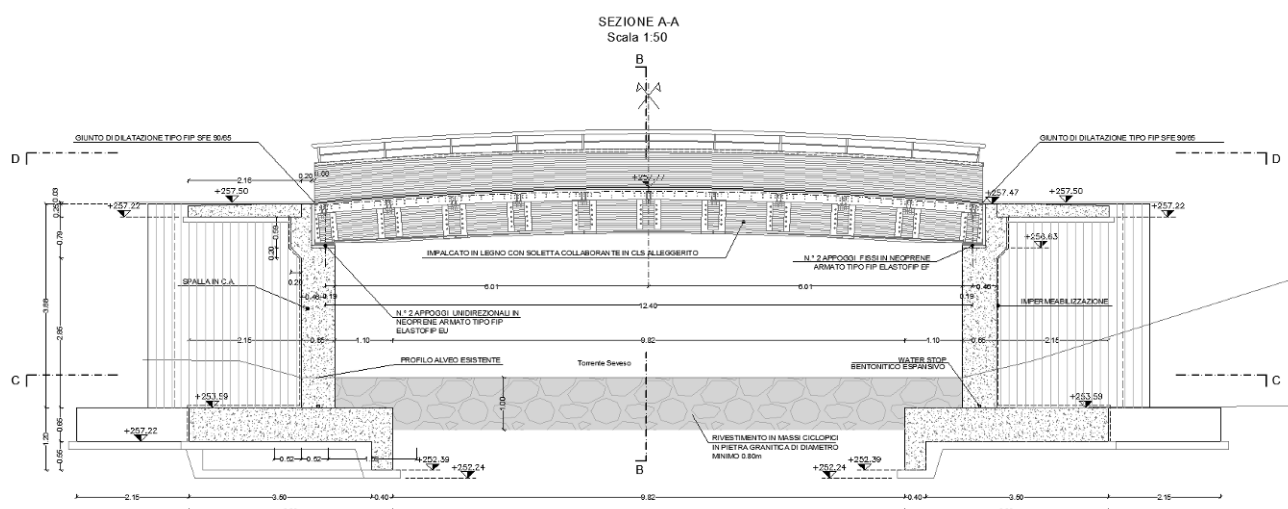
Sezione del ponte in progetto di via dell'Abbazia
